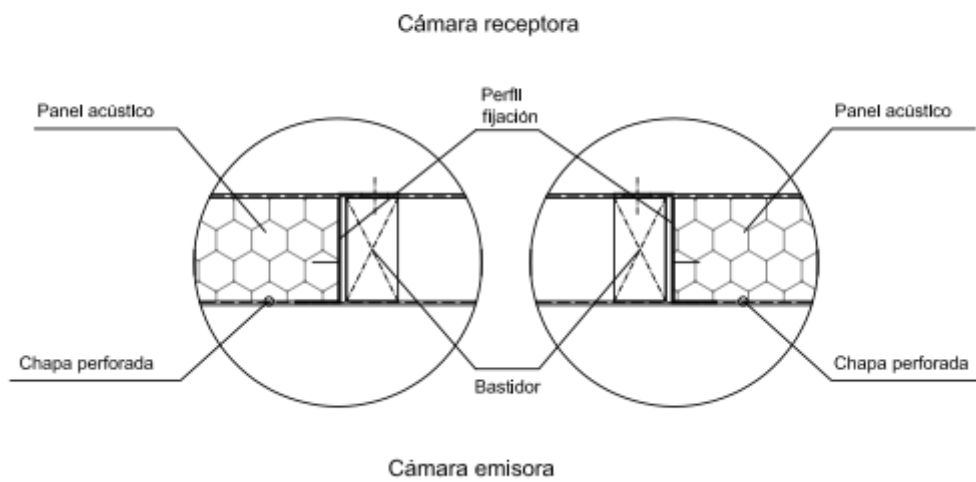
Detalle del perfil de fijación para el bastidor A sustituyendo los paneles centrales.
